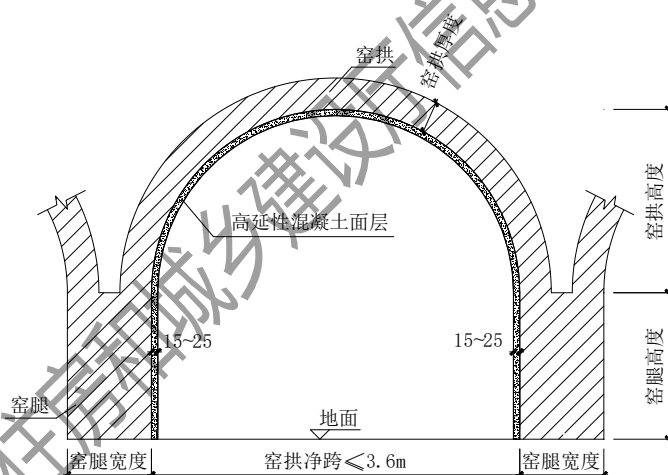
高延性混凝土面层加固窑洞剖面示意图
